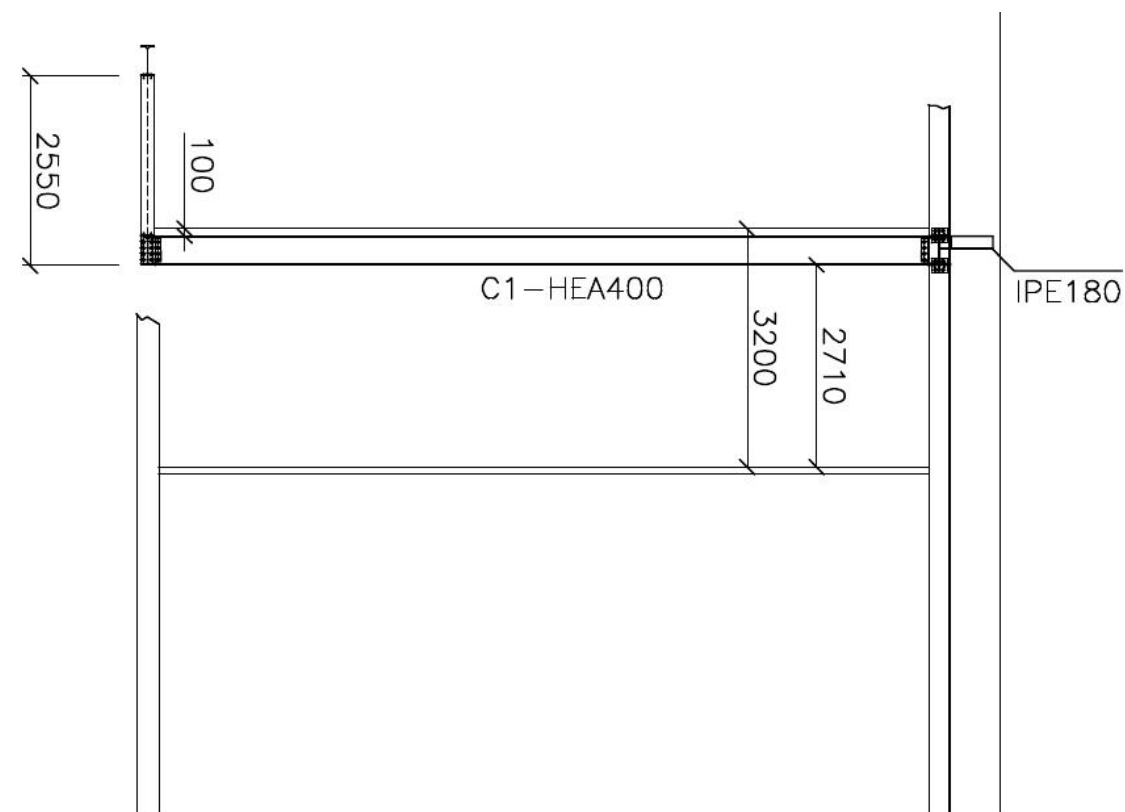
Particolare di A.2007.a.sa.T01 - Progetto della struttura - Sezione trasversale tipo
